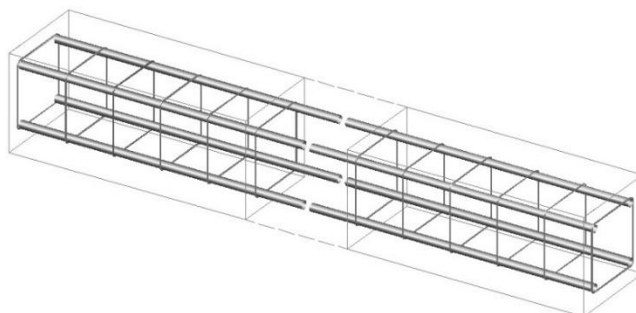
Ligação Viga – Viga por betonagem *in situ
